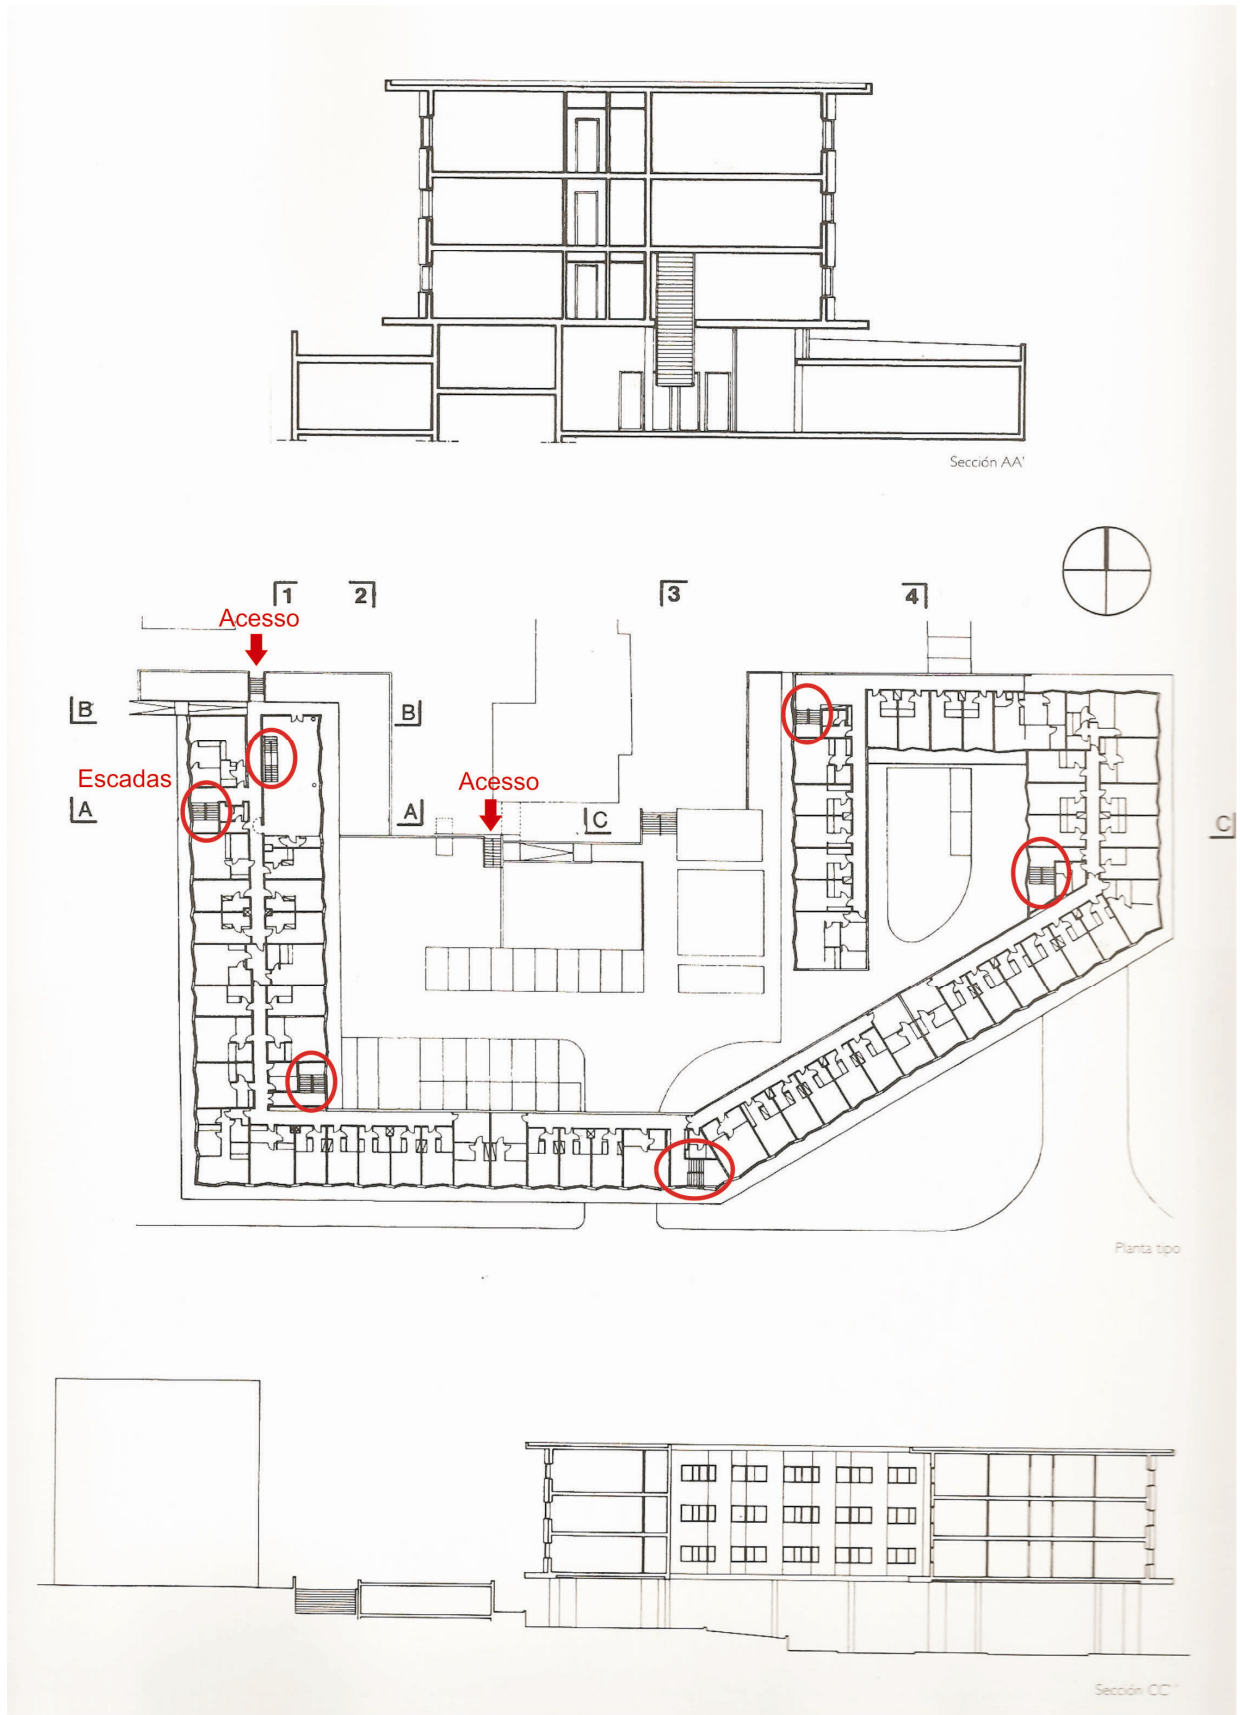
Planta baixa e cortes.(HUBER, Wilhelm)
